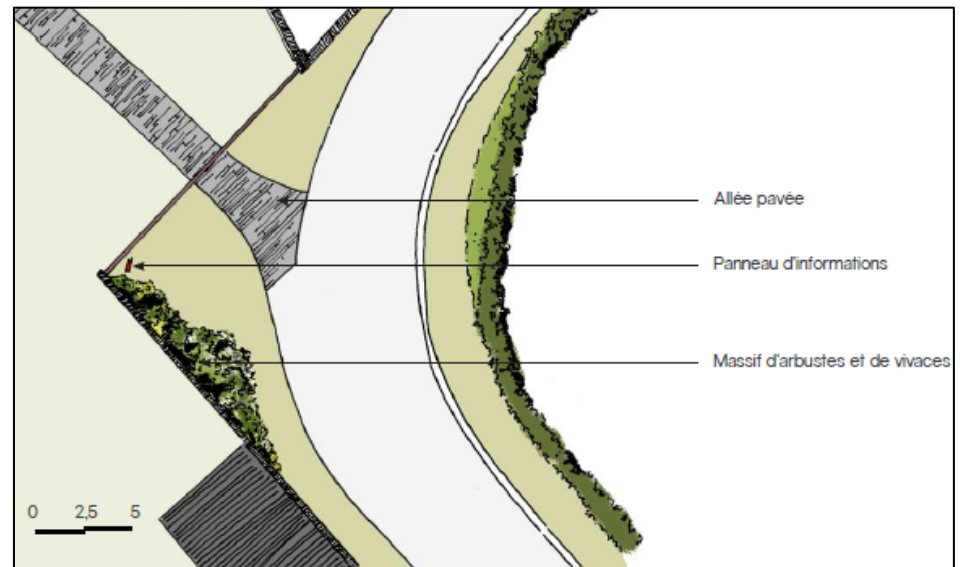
Proposition d'aménagement pour le portail du château de Beaucamps
